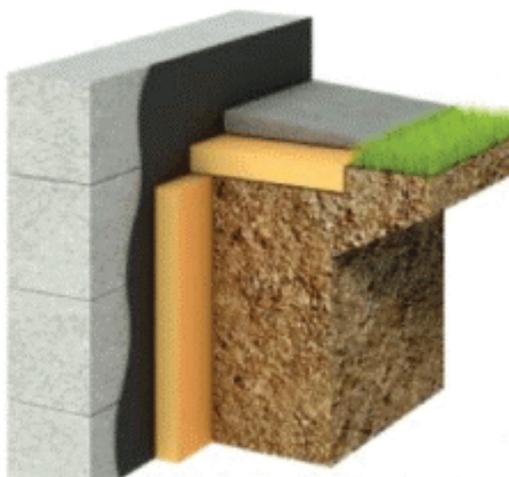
Теплоизоляция и гидроизоляция фундамента
